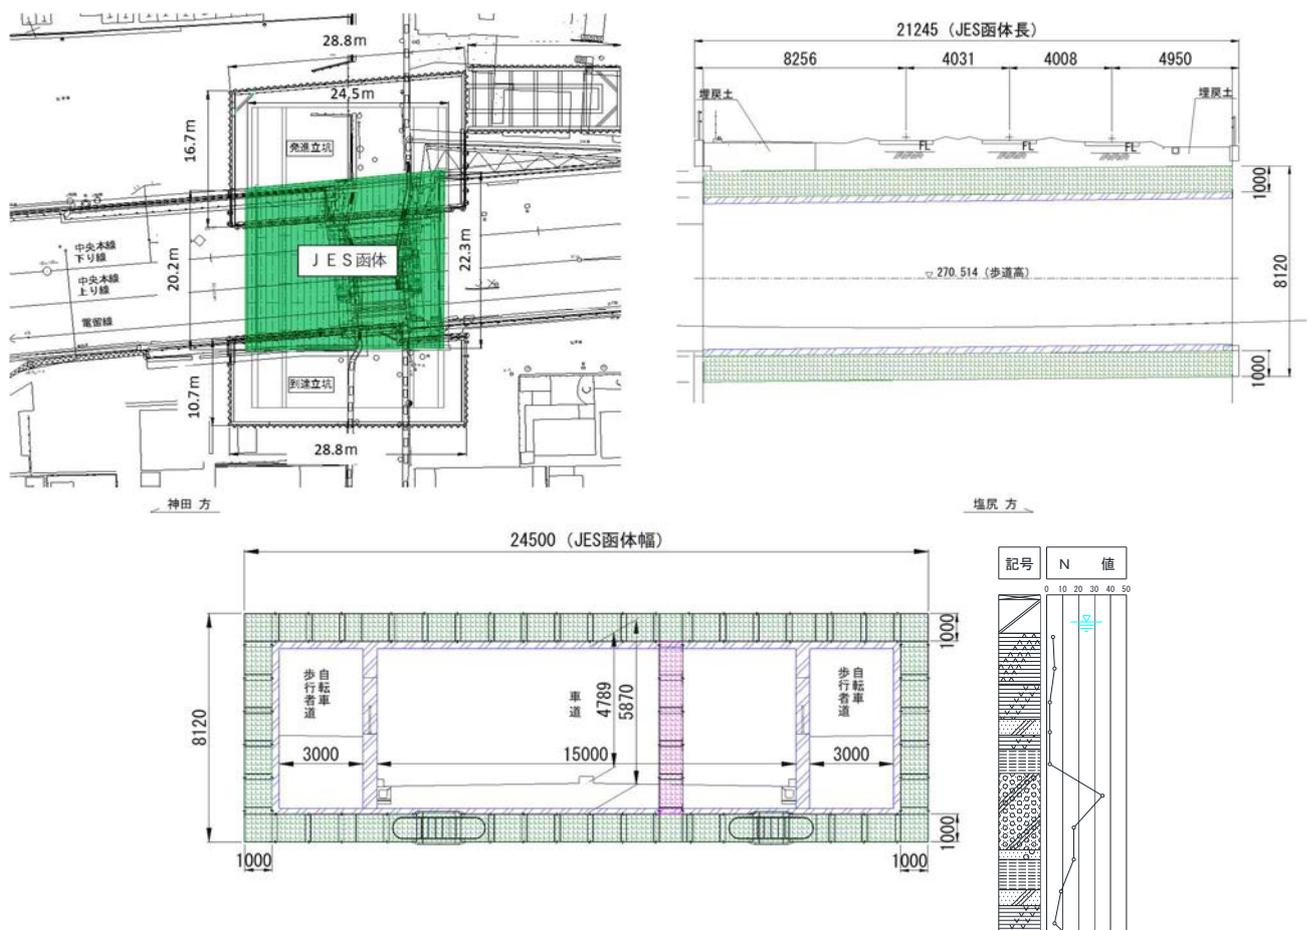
横沢架道橋 概要図（上段：平面図，側面図 下段：断面図）
